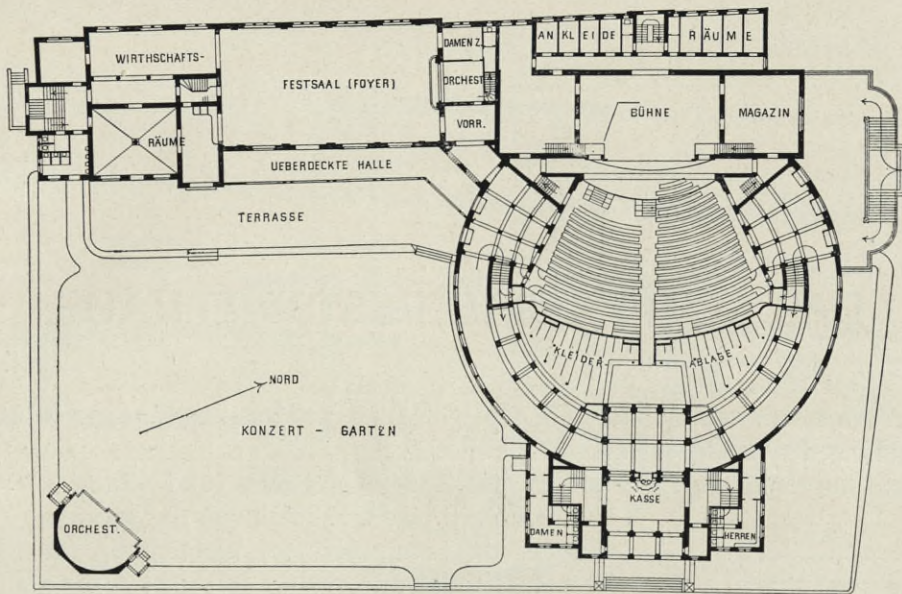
Festtheater zu Worms <sup>105)</sup>. Grundriß.
